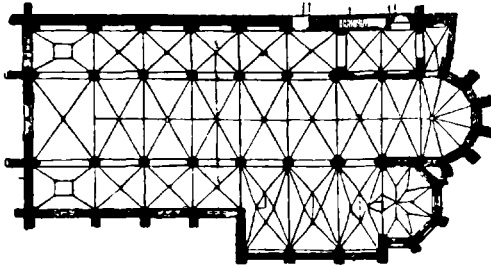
Grundriss der Dominikanerkirche zu Maastricht. Nach Vermeulen.
